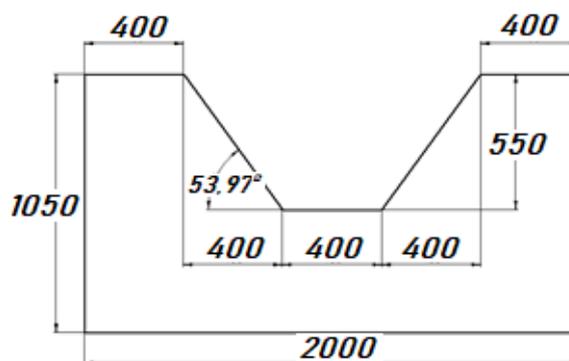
Общий вид и размеры канала в поперечном сечении
